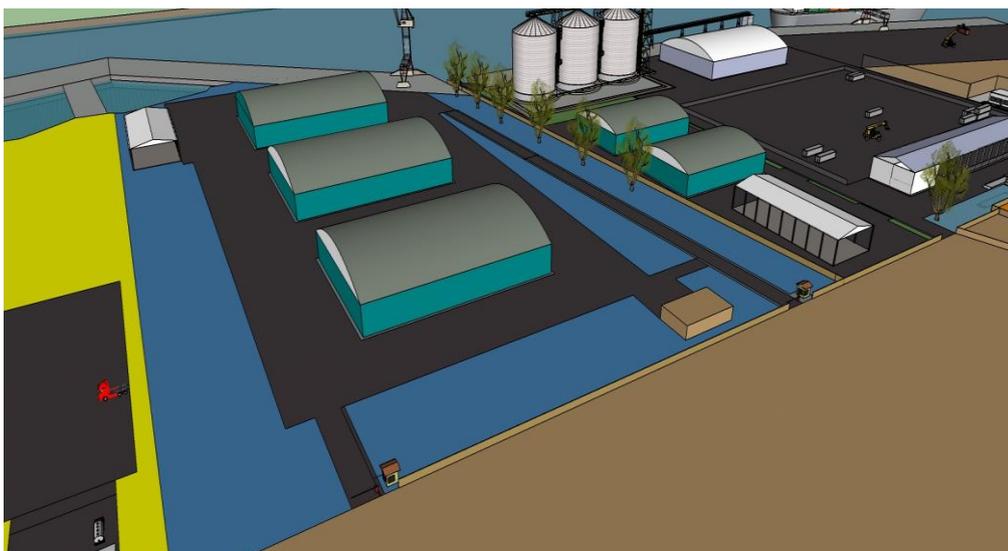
Instalação de 03 galpões para cargas gerais.
